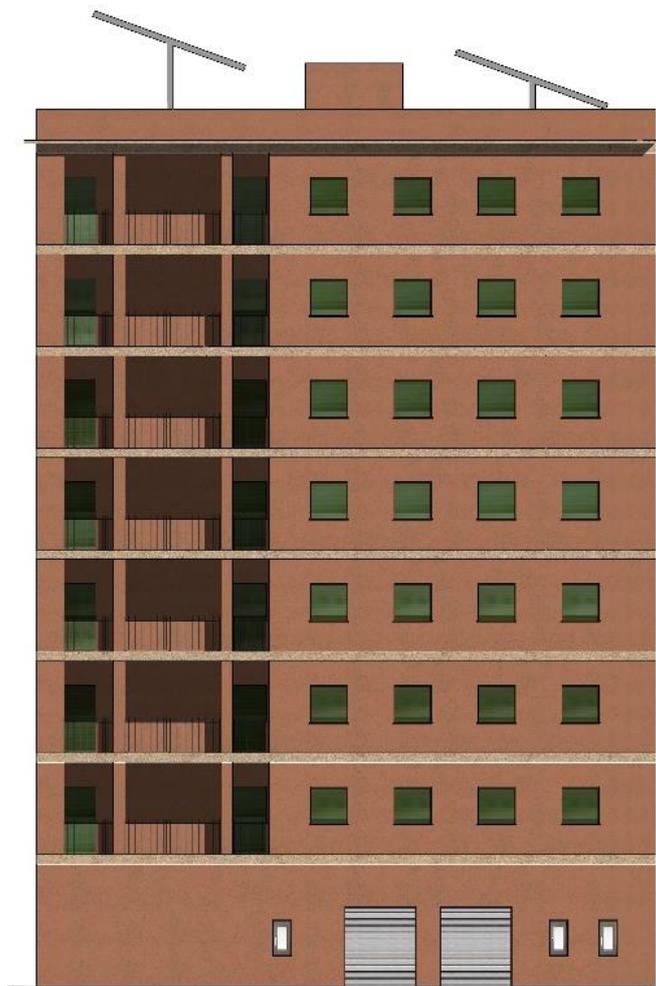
Prospetto ovest con rappresentazione delle pensiline in copertura
